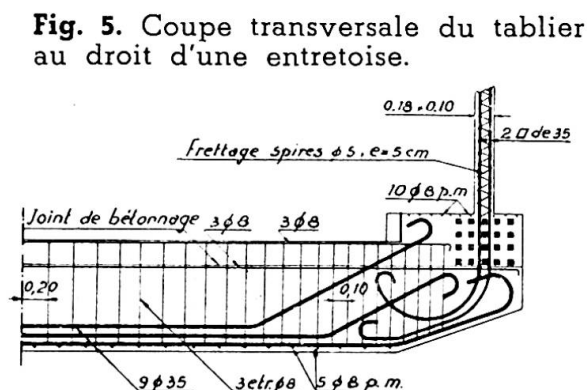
Coupe transversale du tablier au droit d'une entretoise.
